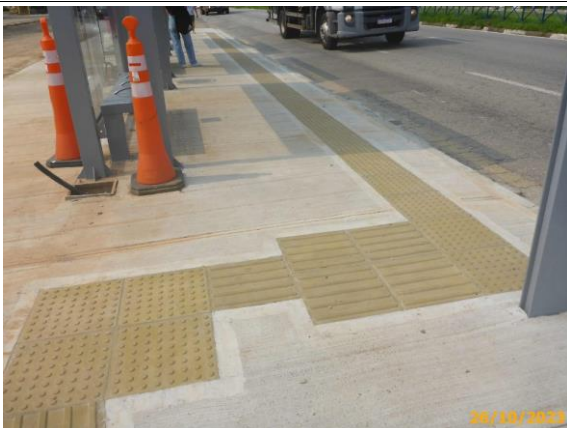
Rejunte aplicado nos ladrilhos táteis.
